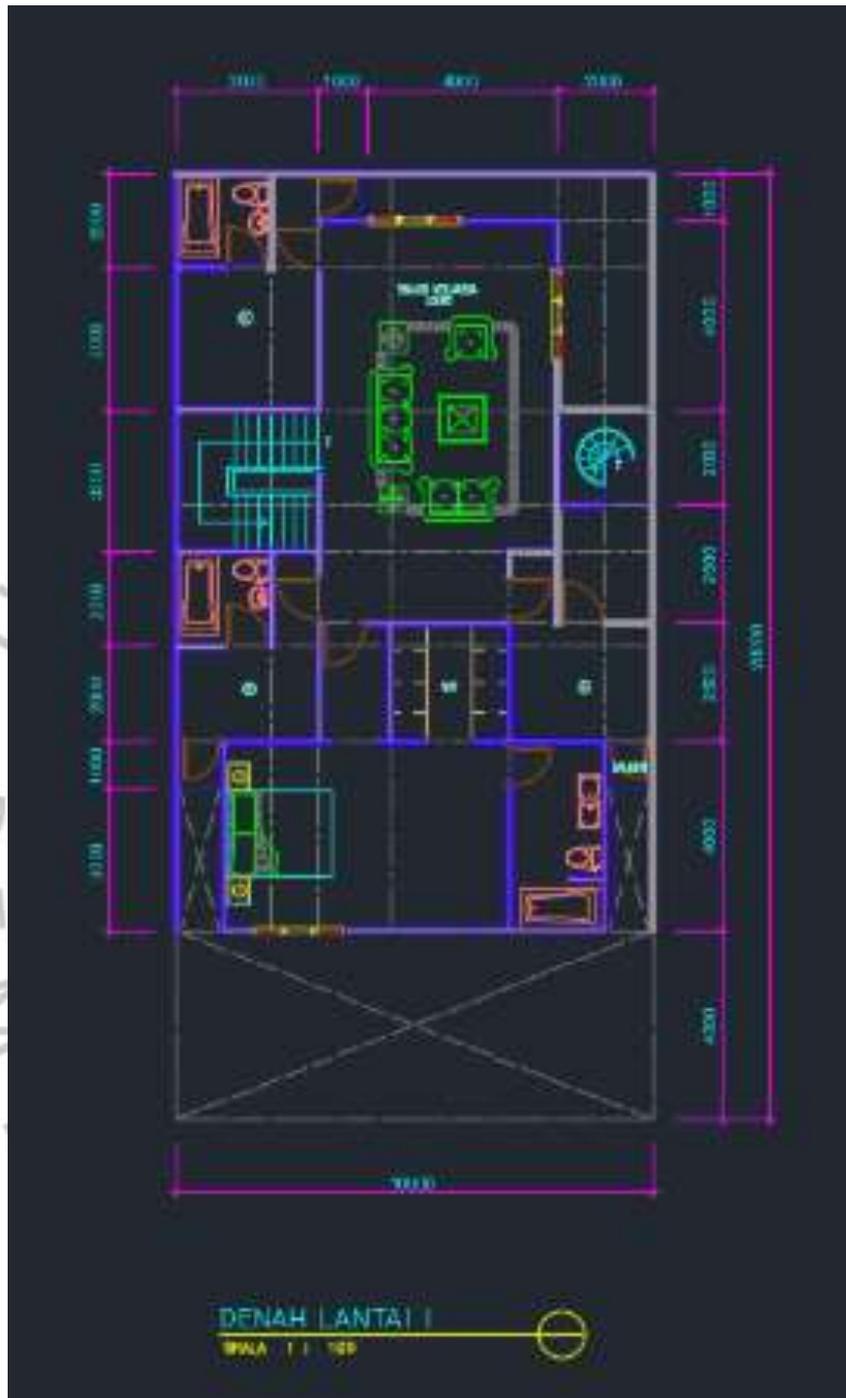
Sketsa Denah Rumah Dinas Cilandak
